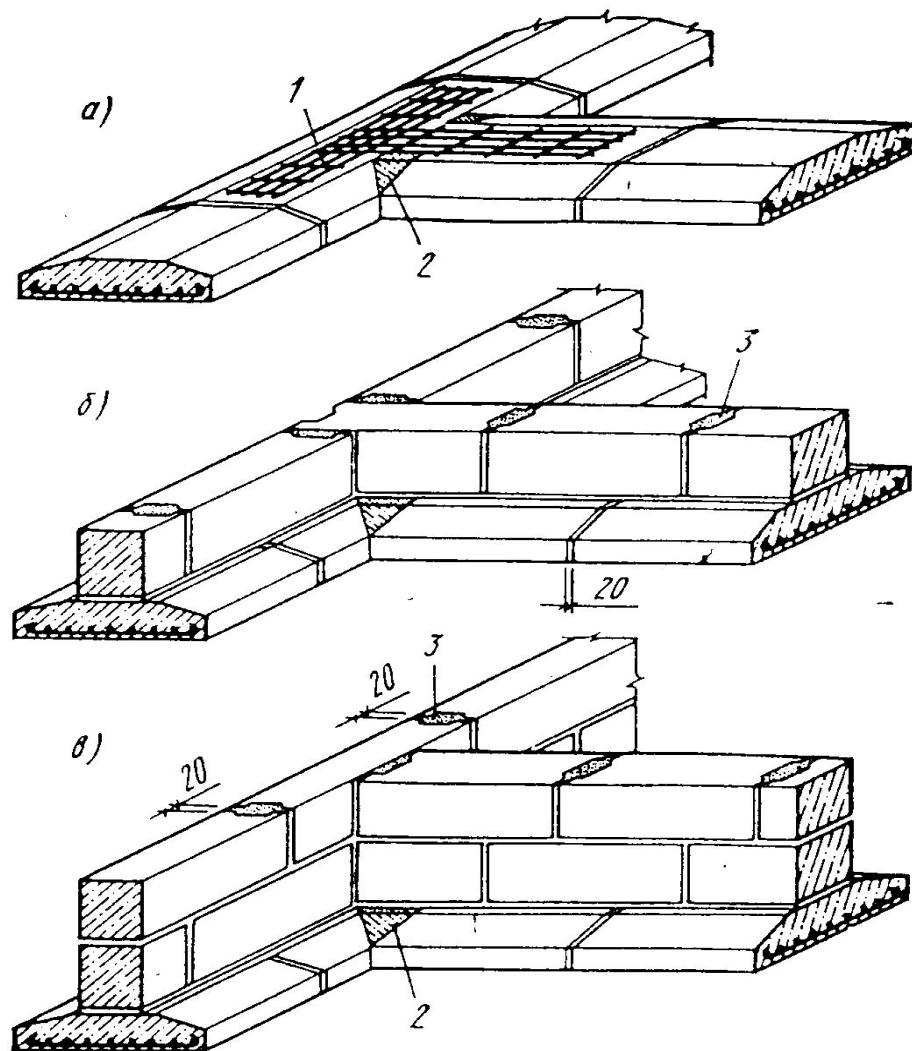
Сопряжение фундаментов продольных и поперечных стен:
